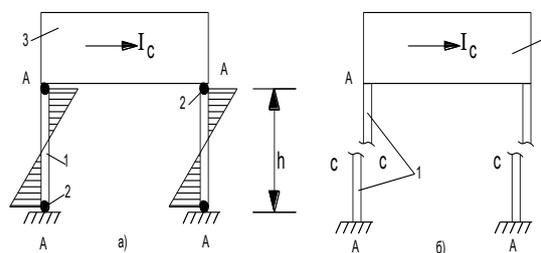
Расчетная схема здания с гибким каркасным первым этажом:
